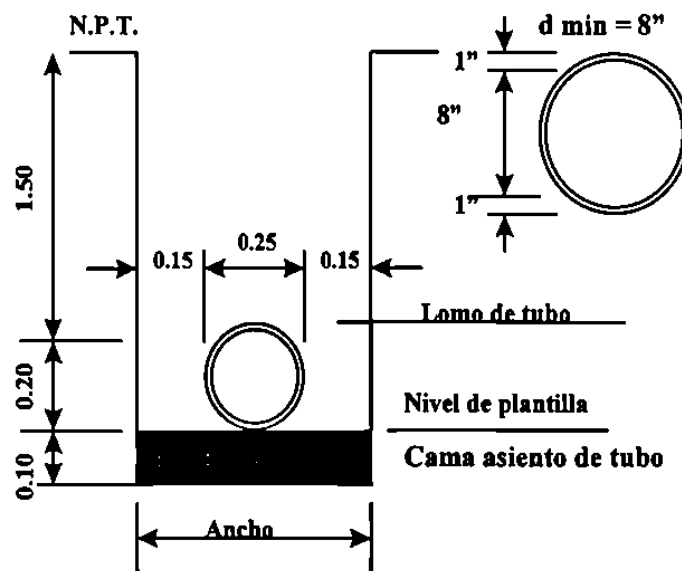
Detalle de una zanja para tubería de red de alcantarillado
